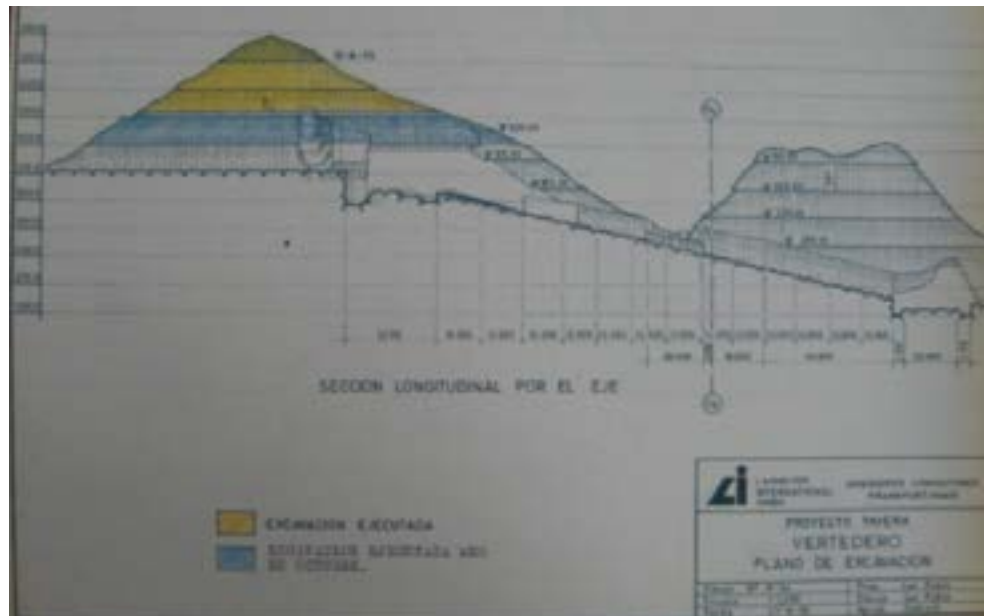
PLANO DE EXCAVACIÓN VERTEDERO DE TAVERA
